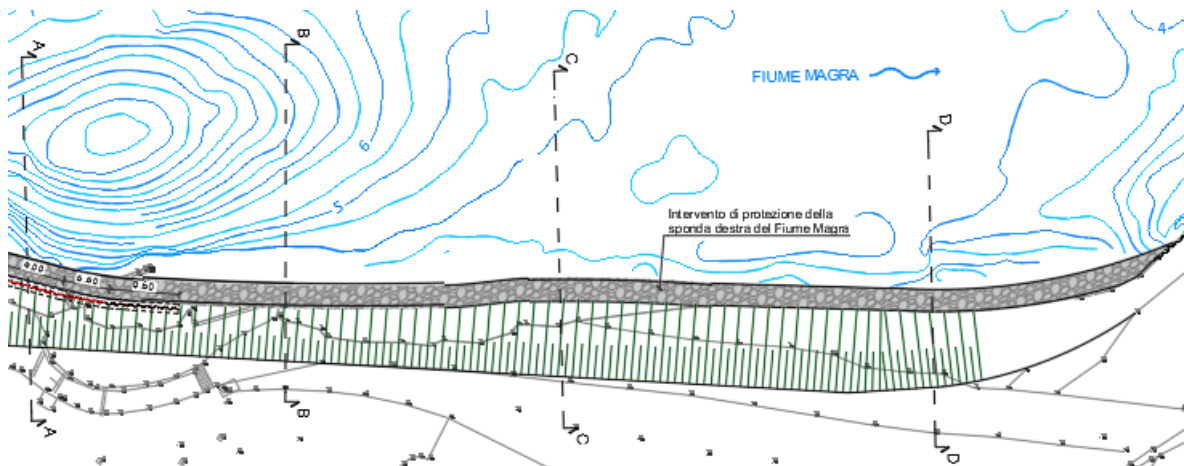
planimetria stato di progetto intervento di ristrutturazione sponda
